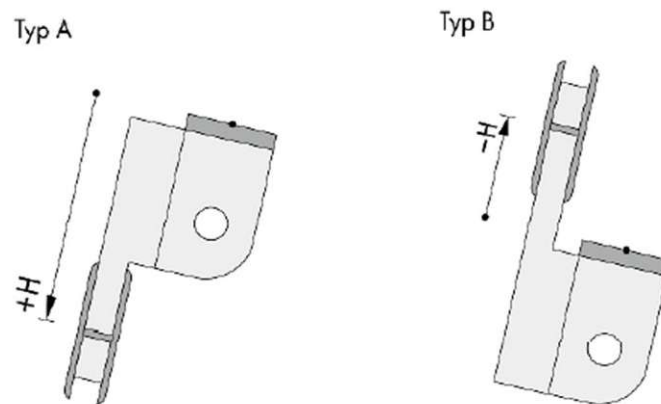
Anbindung der Fassade mit typisierten Details [43]
